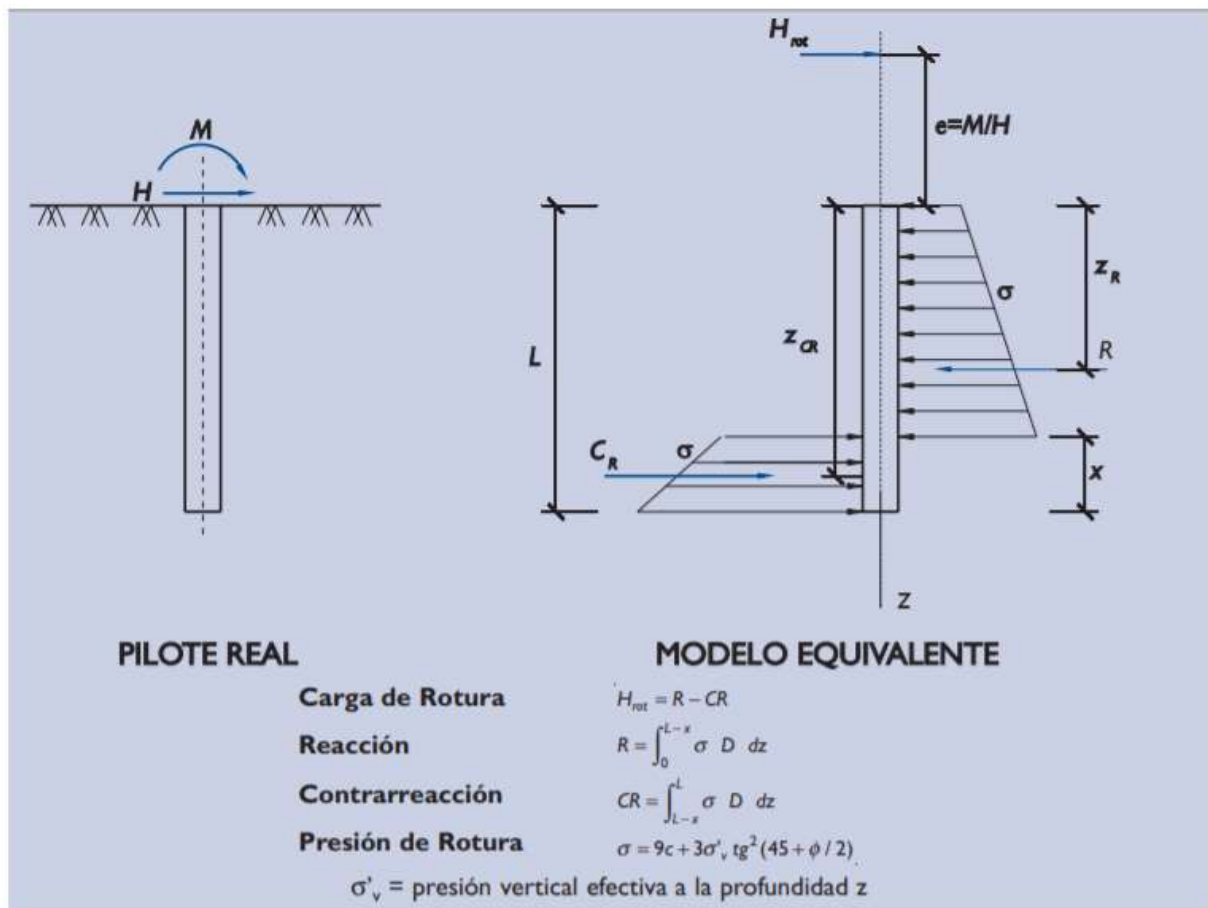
Esquema de cálculo de la fuerza horizontal de rotura.
